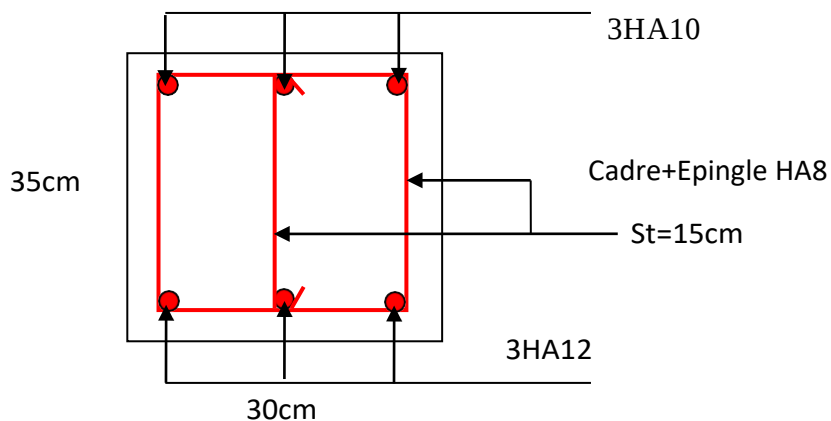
Schéma de ferrailage de la poutre de chaînage
